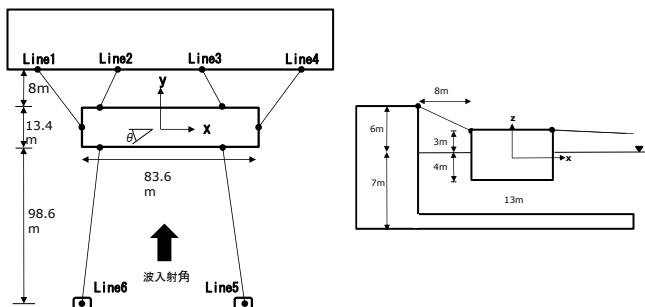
係留配置(平面図) 図-3 係留配置(断面図)
